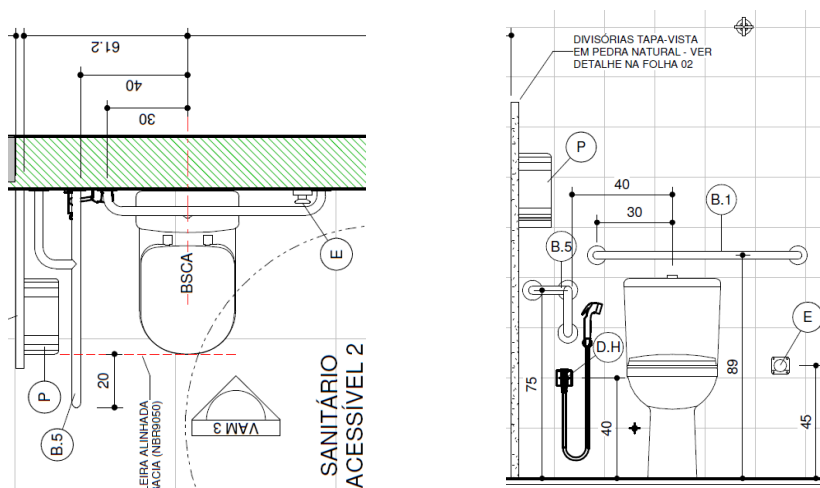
Vistas com barra de apoio (B.5) lateral fixa à parede do fundo
